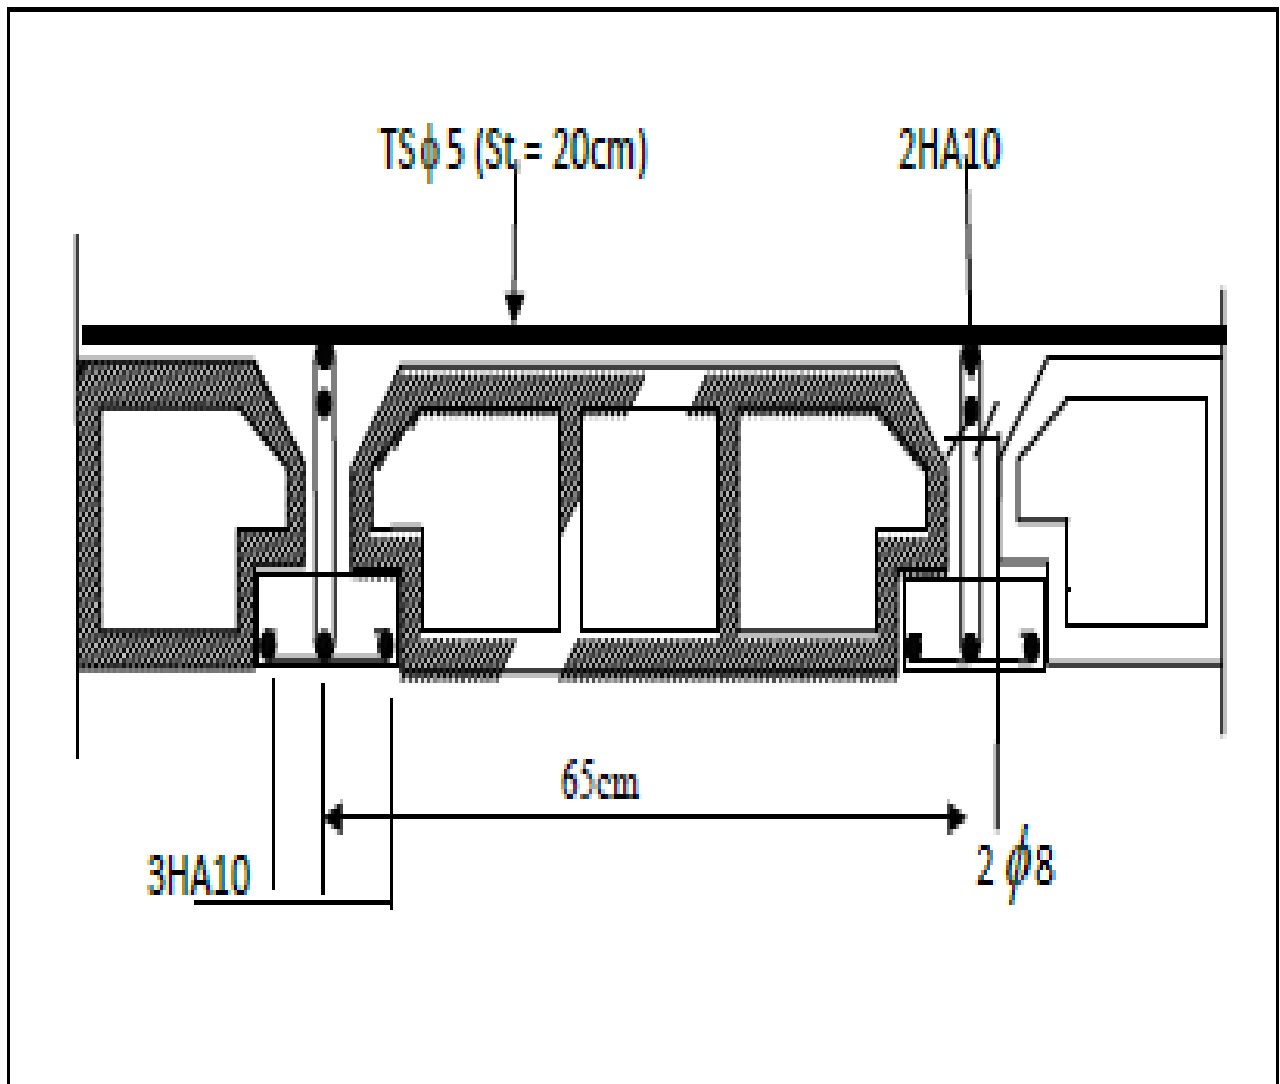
Plan de ferrailage du plancher étage courant en corps creux.
